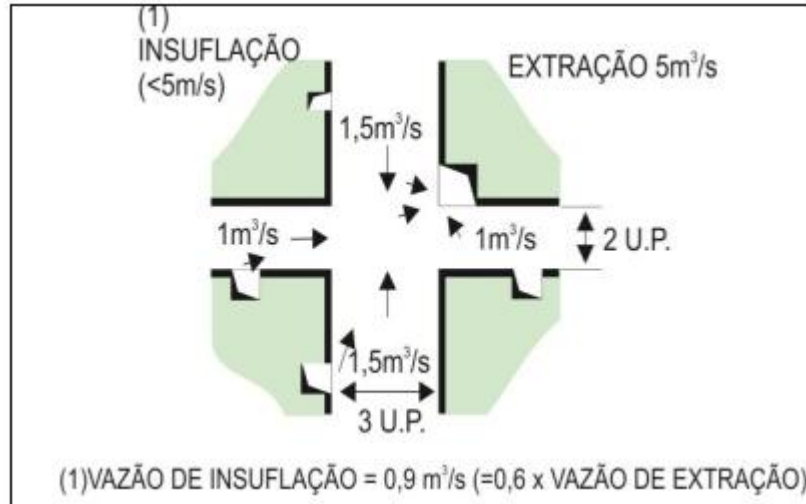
Resumo geral de aberturas de extração de fumaça e entrada de ar em um pavimento
